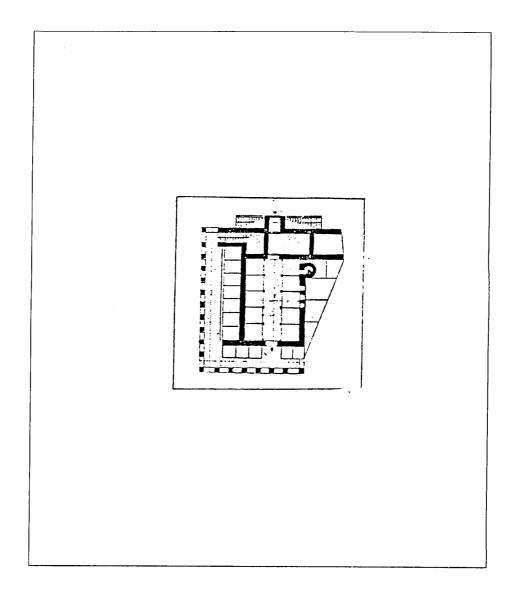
مسقط أفقي لبادستان رستم باشا المعروف ببادستان بورصة في سراييفو (شكل ١٦٨) مسقط أفقي البادستان رستم باشا المعروف بادستان بورصة في سراييفو
